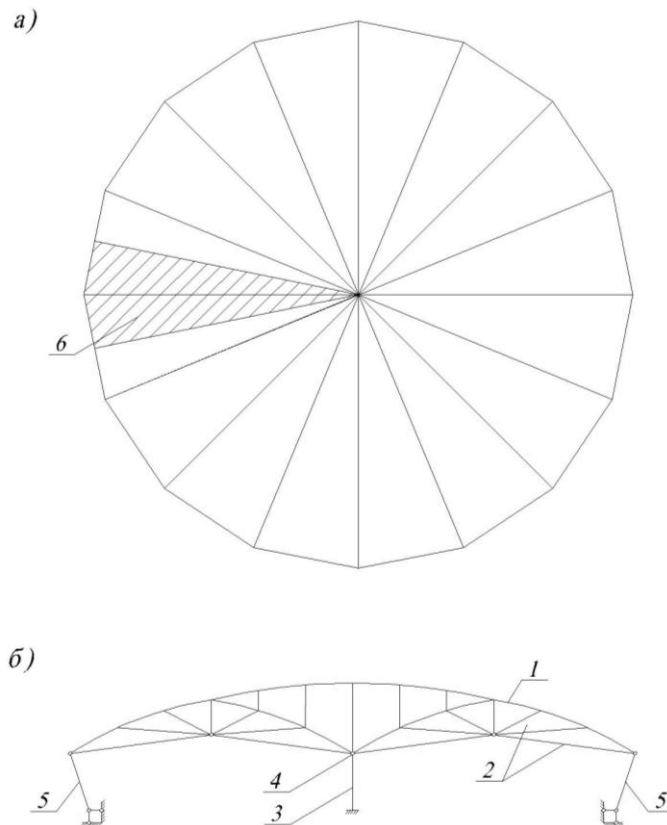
Конструкция покрытия для круглых в плане зданий:
